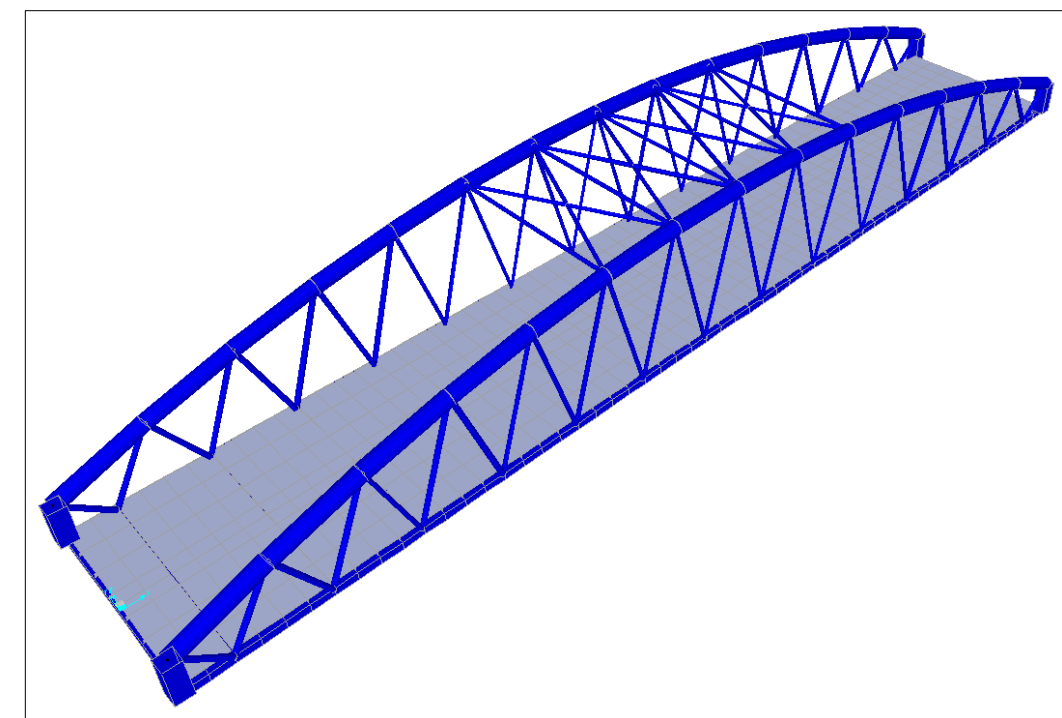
Vista 3d modelo Sap2000, vista con las placas de hormigón (Fuente: elaboración propia)
